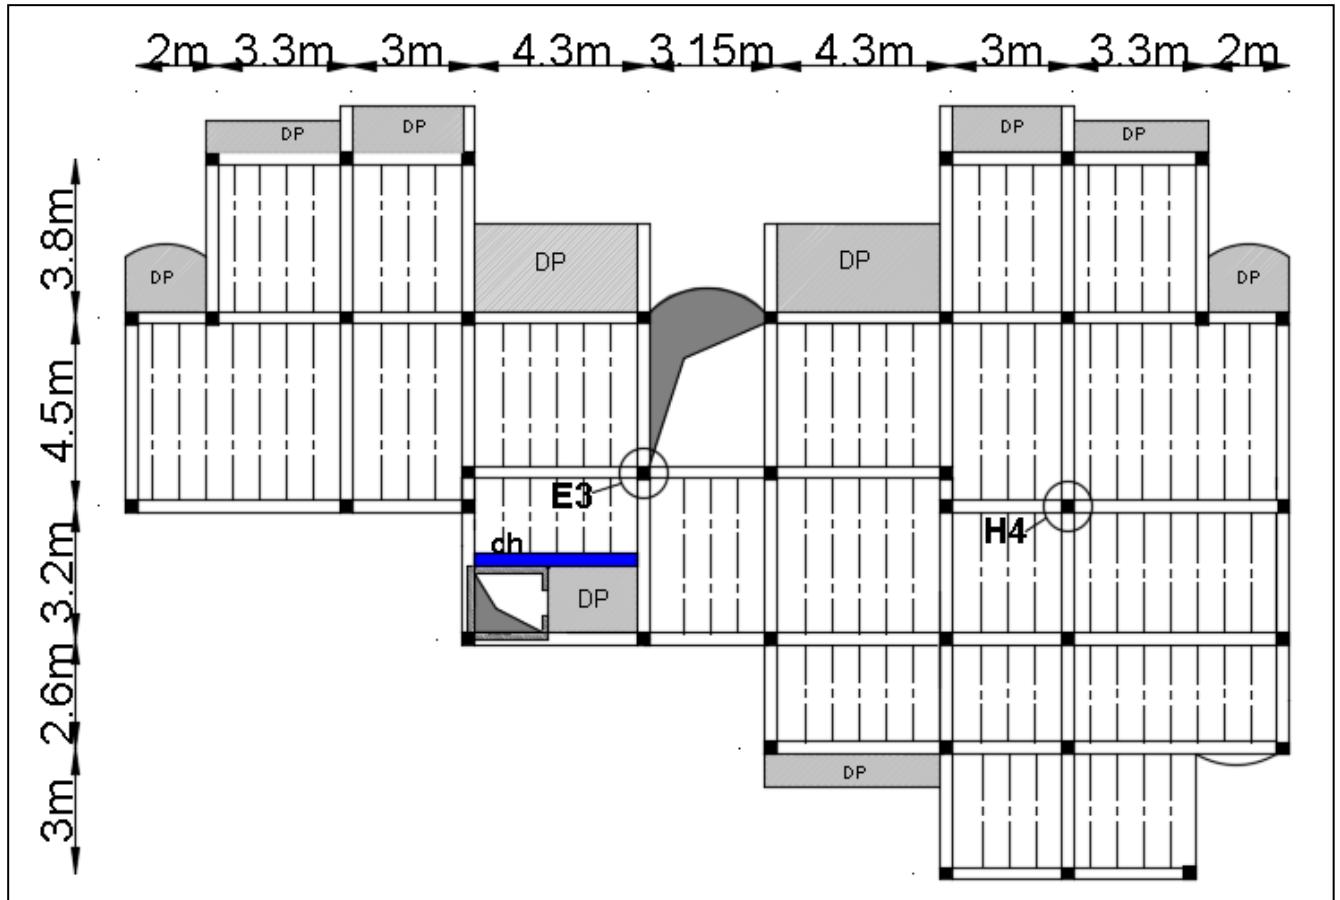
Schéma de la disposition des poutrelles pour les étages
